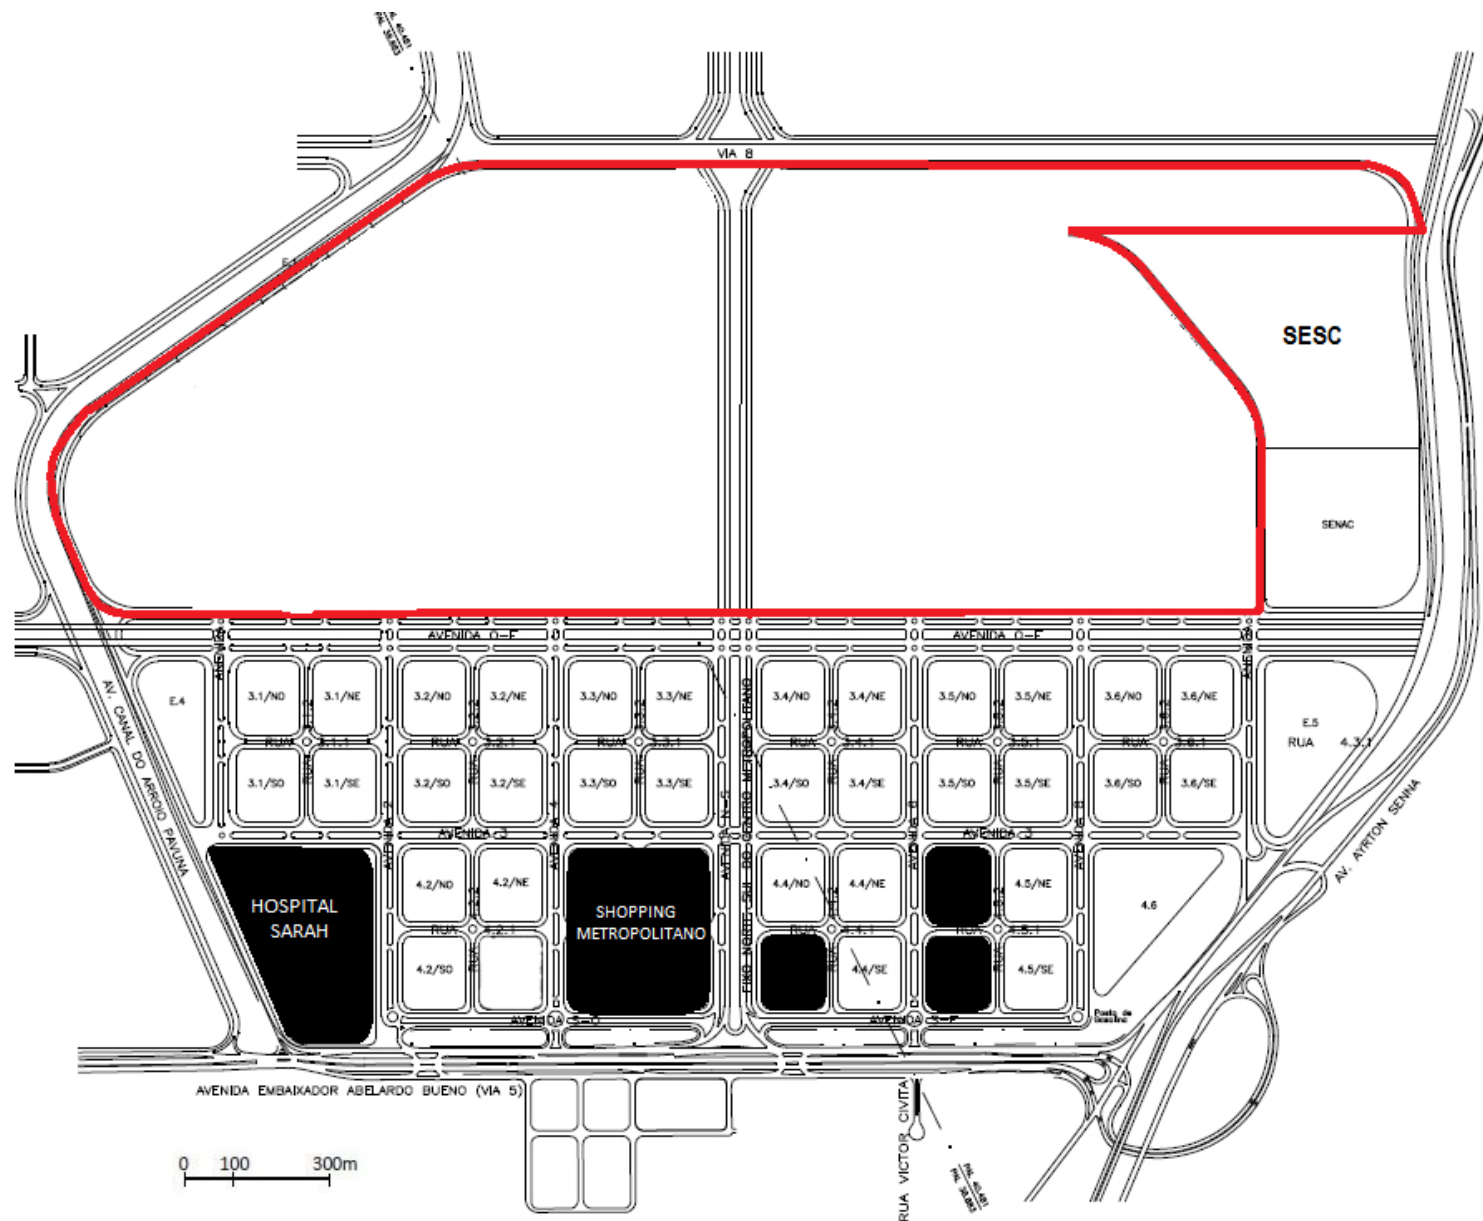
Planta Baixa do Centro Metropolitano. Definição da zona de trabalho, face norte da área. (Planta do Desenho Urbano adaptado pela autora, tendo como referência a planta base do Projeto para desmembramento do lote 1 DO da quadra 4.2 SE do PAL 38.883 elaborada pela ConstrutoraCarvalho Hosken 16/12/2012 ver Anexo B).
